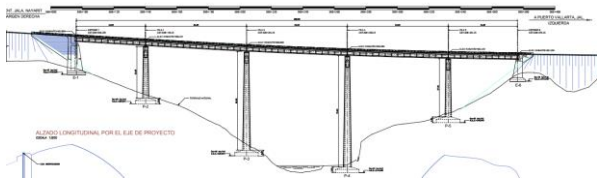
Alzado de la tipología con tablero empujado, proyecto de Mexpresa.
